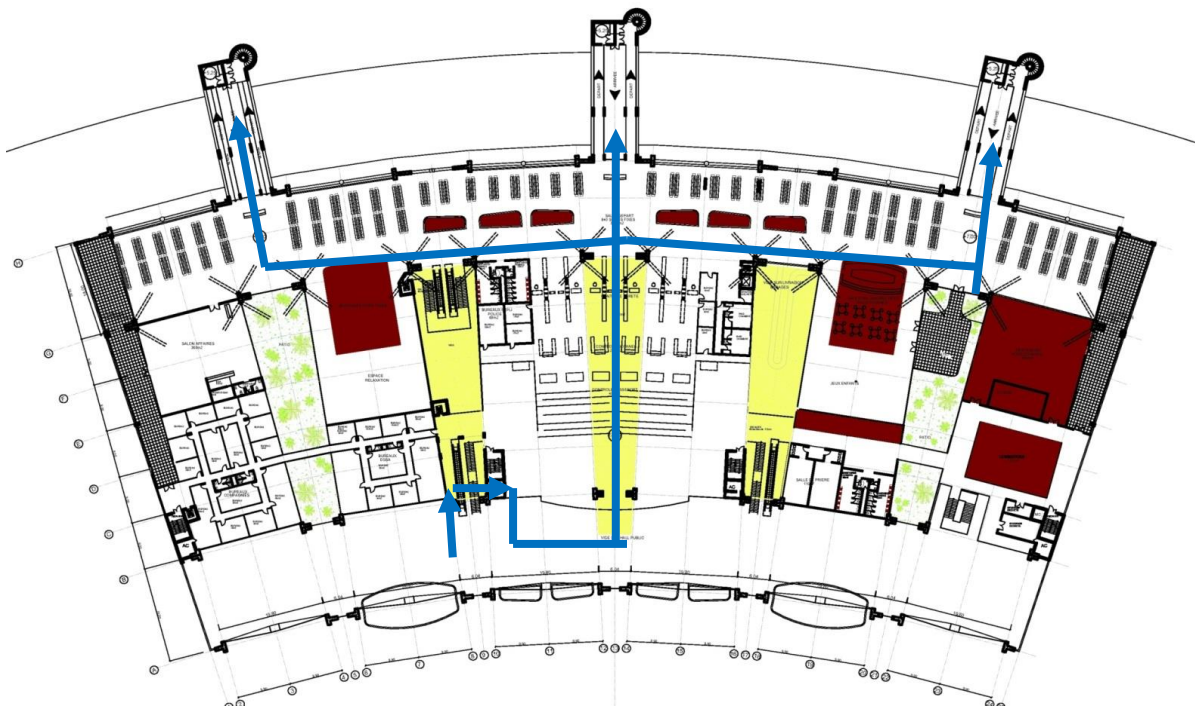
Cheminement passagers -Plan du 1er étage
